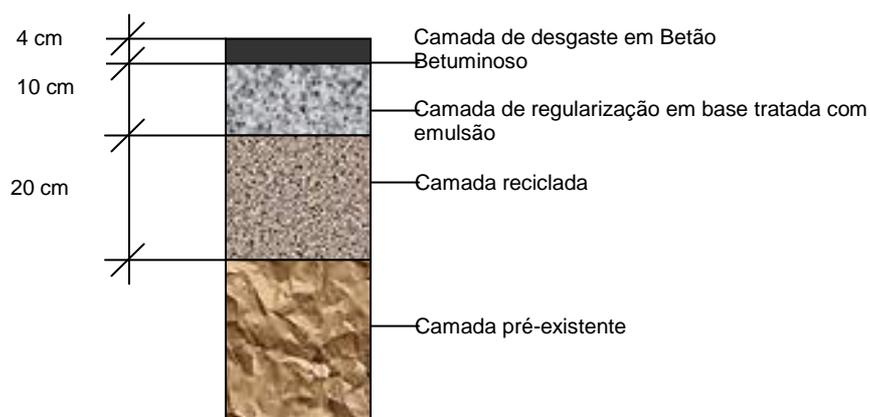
Estrutura final do pavimento rehabilitado (EN222 – Régua/Ponte das Bateiras)
